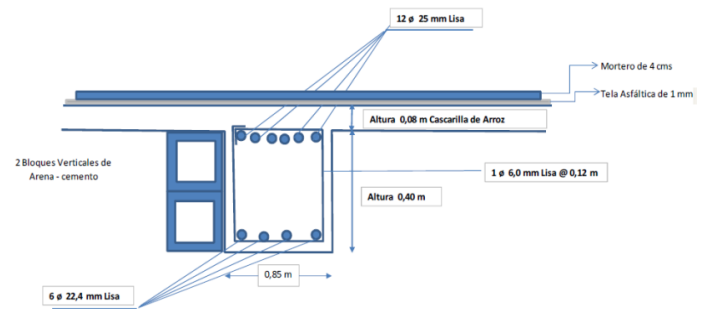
Viga C entre Ejes 6-7 Tercer Piso Segunda Placa
